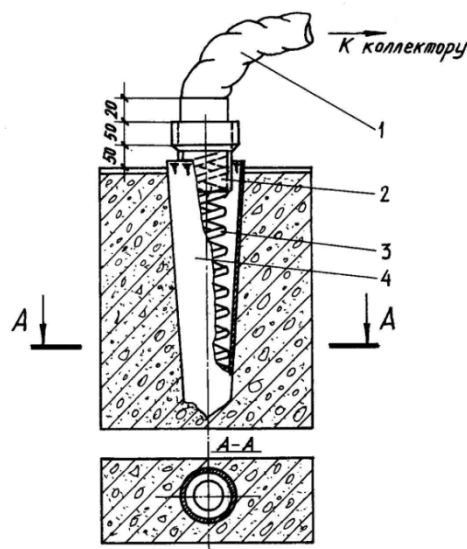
Вакуумтрубка разового использования: 1 – резиновый всасывающий шланг; 2 – металлический патрубок; 3 – стальная проволочная спираль; 4 – фильтровальный рукав
